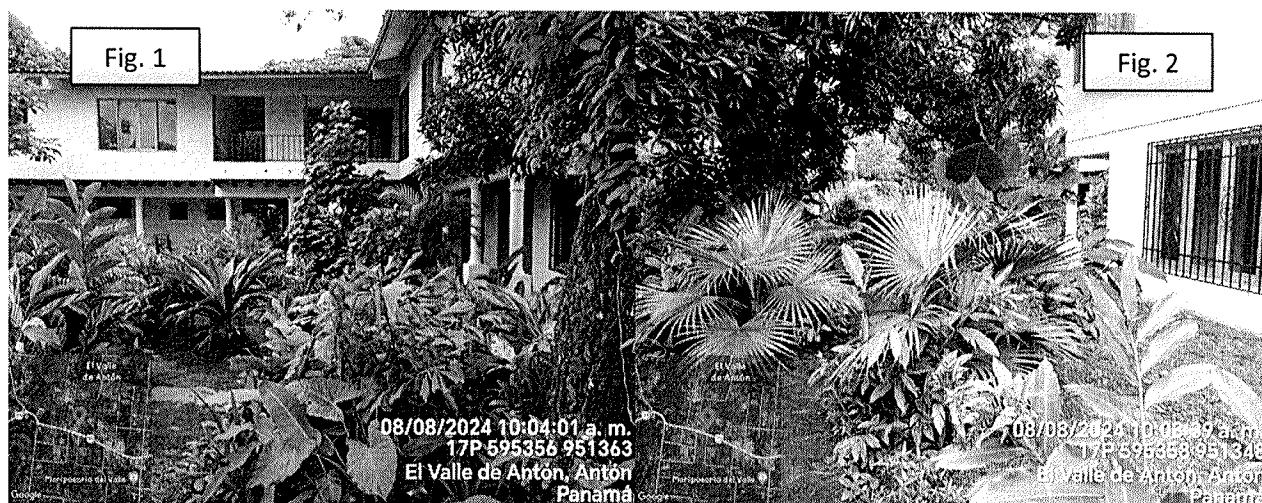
y Fig.2. Se evidencia que se encuentra construida y finalizada la primera fase que indica el EsIA, la cual consistía en la construcción de cuatro (4) locales comerciales en planta baja, y construcción y adecuación de cinco (5) habitaciones en planta alta, cada una con servicios básicos y amueblados y un jardín.
